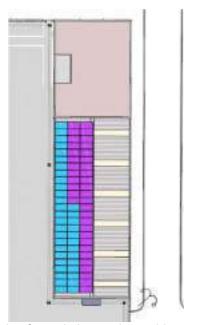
Distribución paneles fotovoltaicos sobre cubierta con orientación más optima
